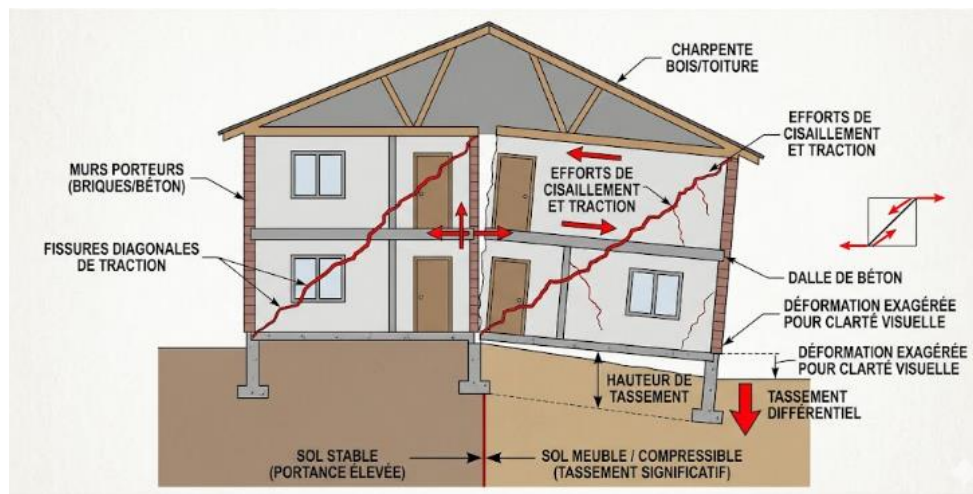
15 : influence du tassement différentiel sur la fissuration d'une structure
